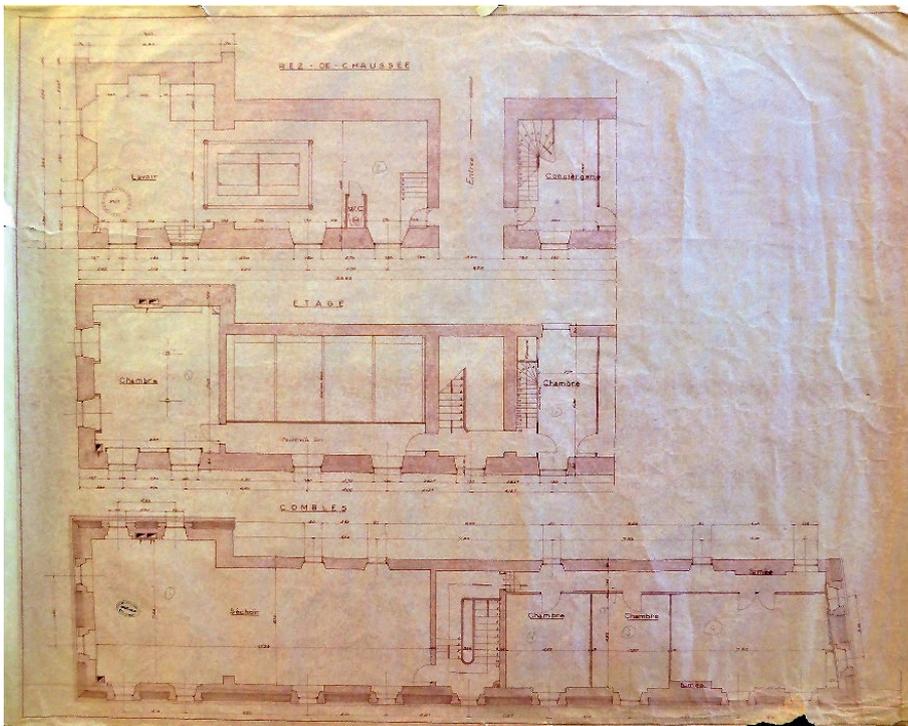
Plans des différents niveaux du logis de l'Intendance, fin XIX^e siècle (AD 37, Villandry, plans, IV/55-4 (6)).
